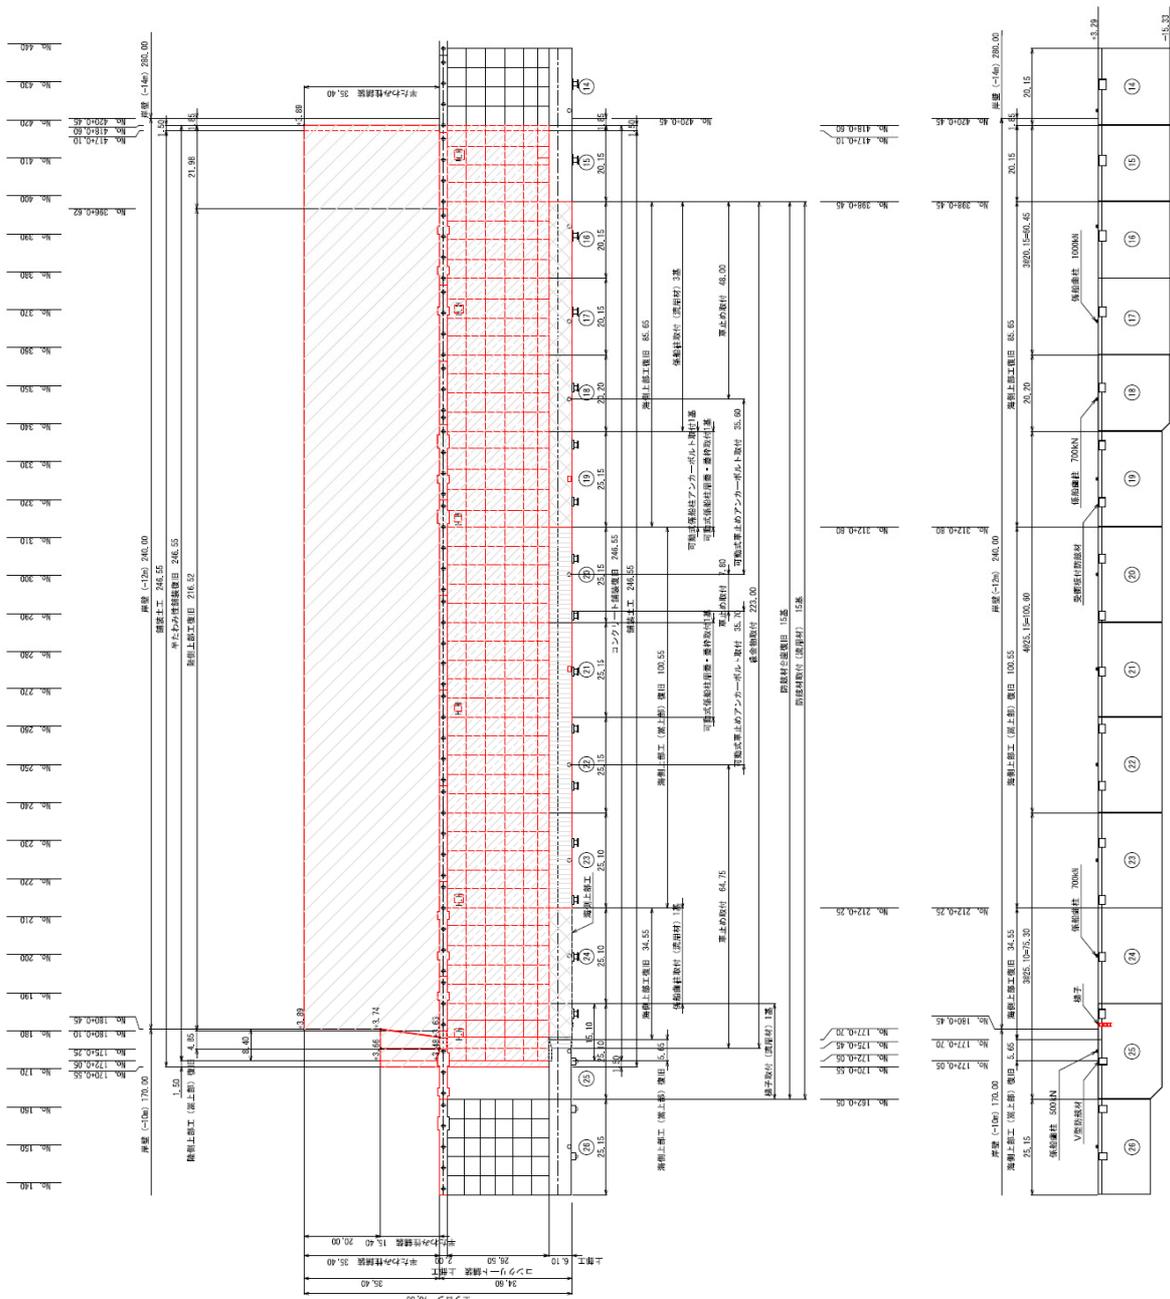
No.5 常陸那珂港区_北ふ頭岸壁(-12m)の平面図 (復旧後)
